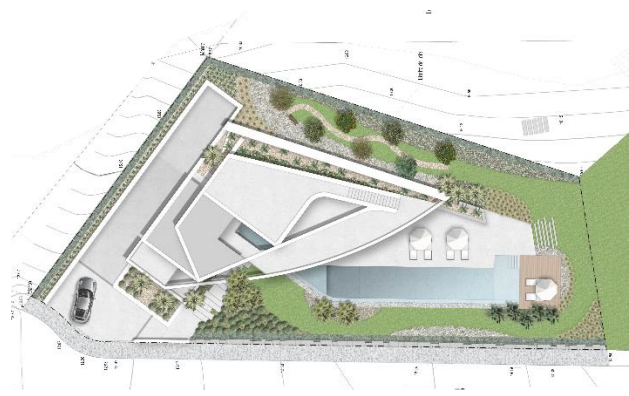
Primeira fase de desenho do Plano Geral do Lote 2087, Vale do Lobo, realizado pela autora. Fonte: Jardim Vista, 2022. Edição: Autora.
